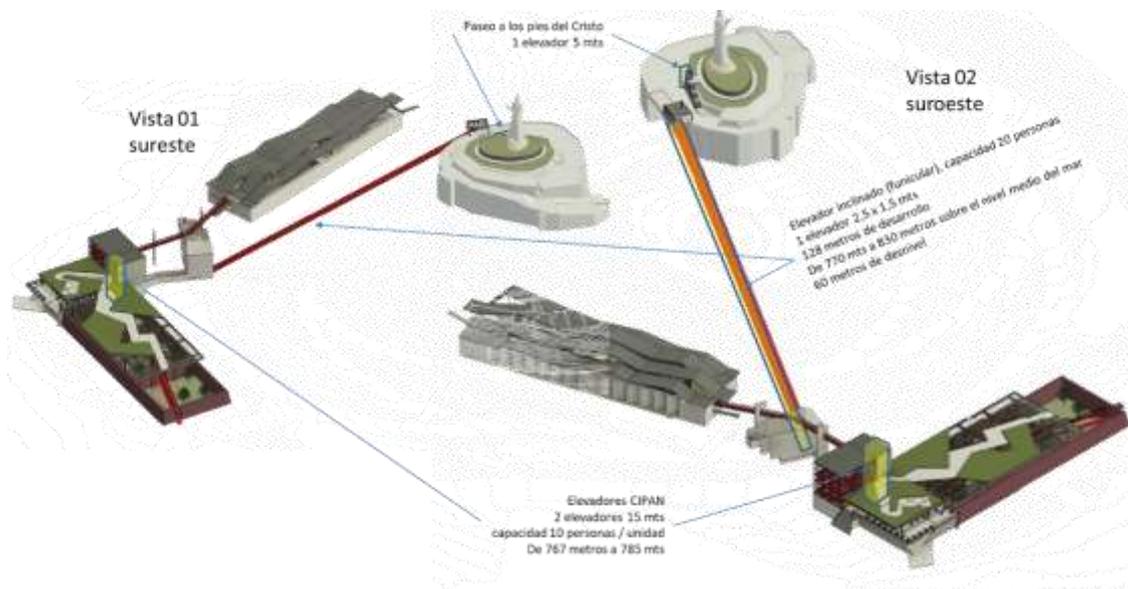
Vistas sureste y suroeste del esquema de elevación al Cristo y su relación con el conjunto de CIPAN.
